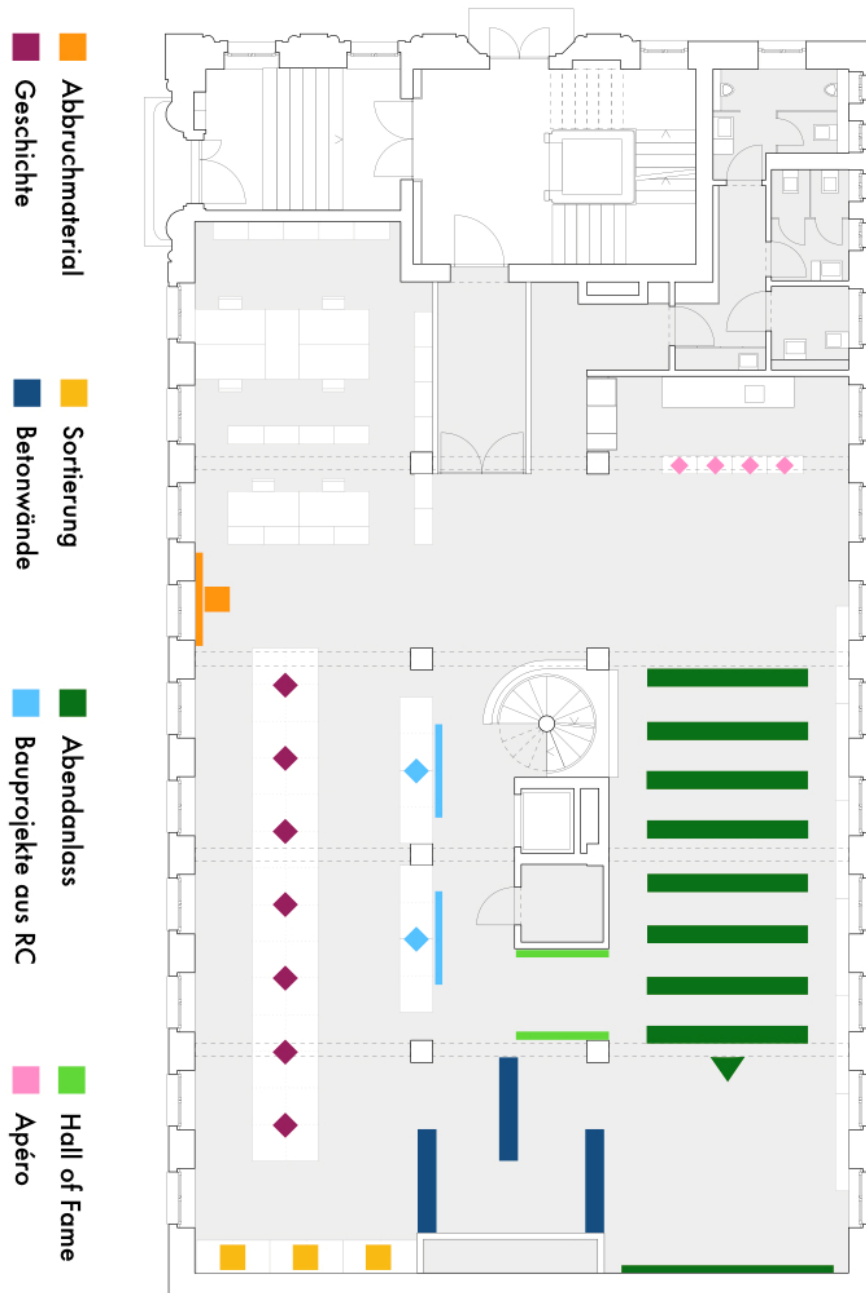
Grundriss der Ausstellung bei einer Abendveranstaltung (eigene Darstellung)
